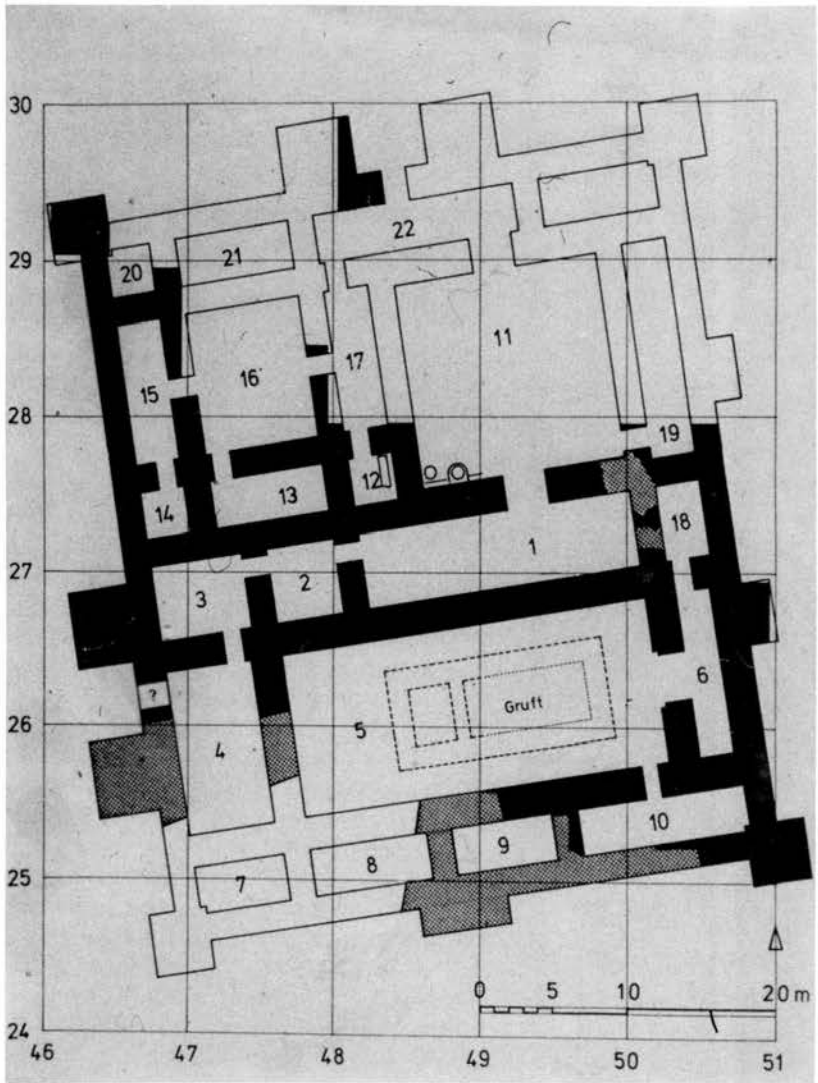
Plan des jungen Palastes mit Gruftanlage in Raum 5.
